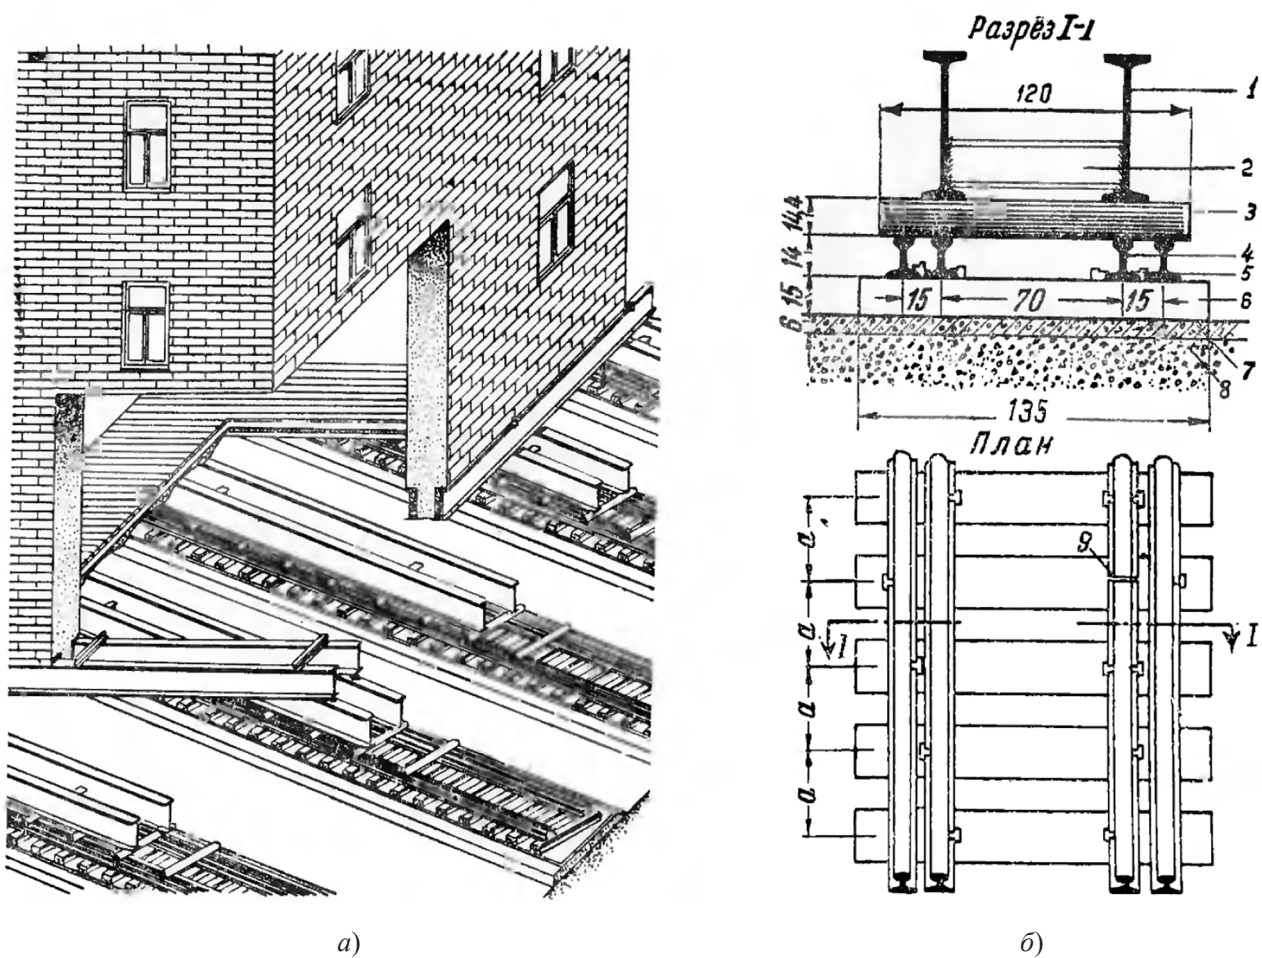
Расположение ходовых путей и рельсов путей для передвижки в косом направлении или с поворотом по способу инж. Э. М. Генделя: а – общий вид; б – детали расположения ходовых балок, рельсов, путей и шпал; 1 – ходовые балки; 2 – диафрагмы; 3 – катки; 4 – рельсы; 5 – костыли; 6 – шпалы; 7 – раствор; 8 – щебень; 9 – стык рельса [3]
